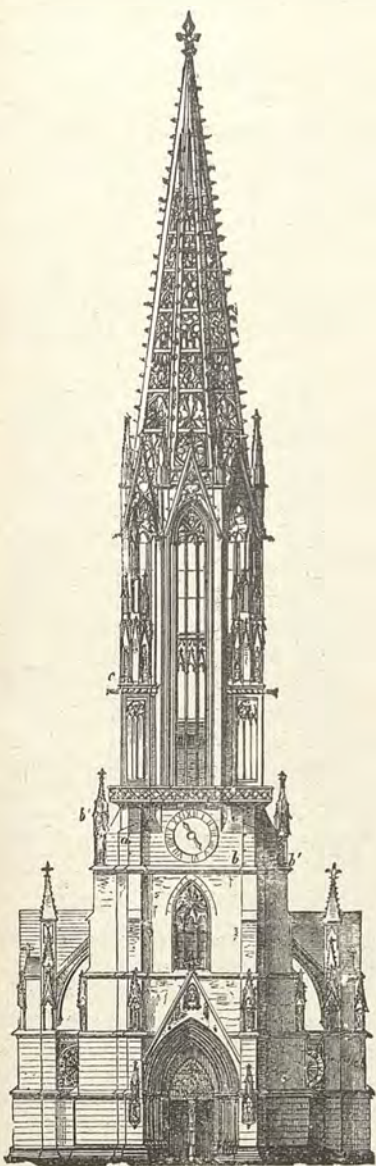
Lato di ponente del duomo di Friburgo.
